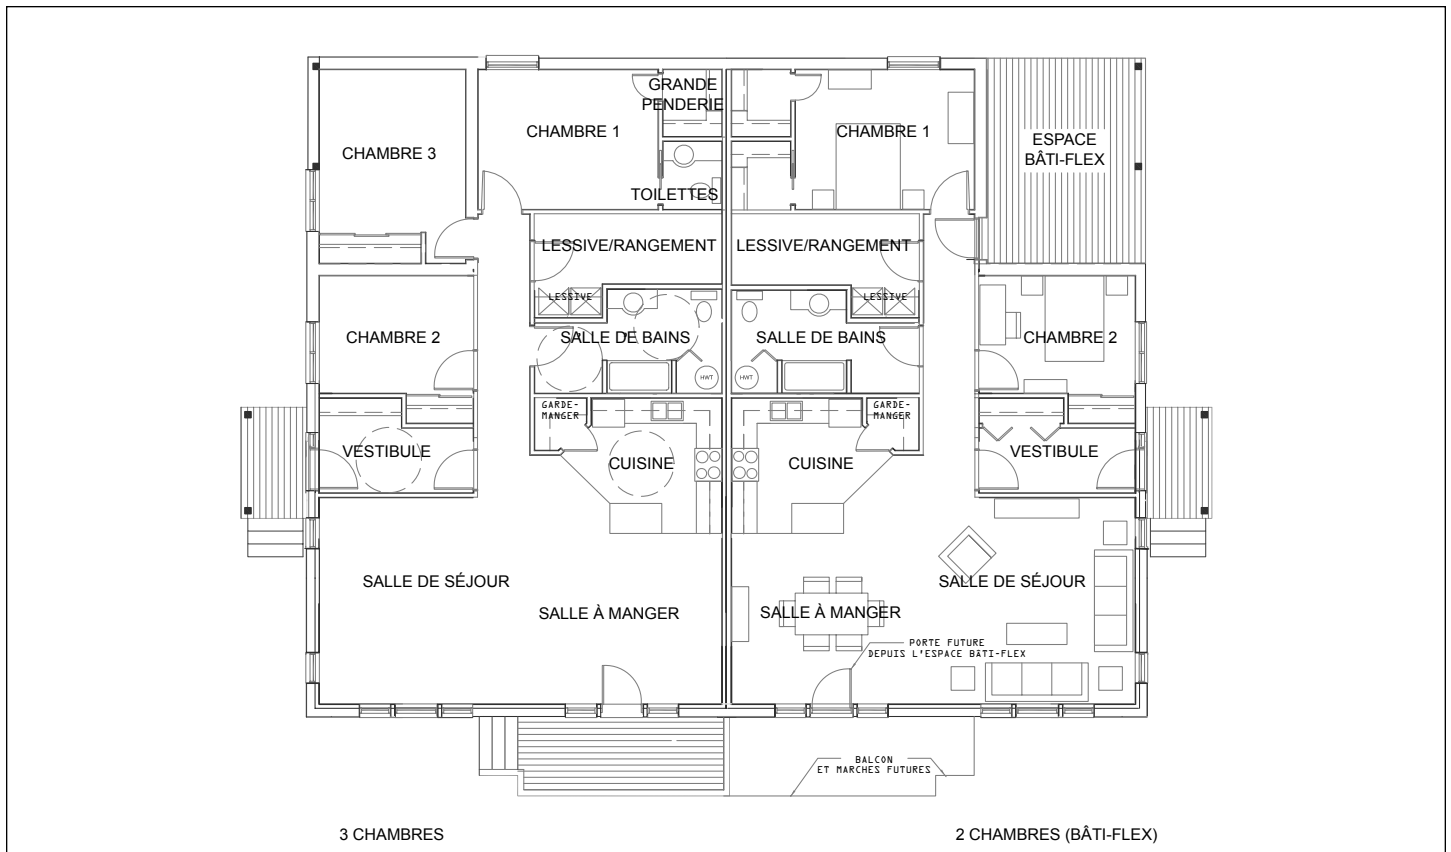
Plan d'étage des logements E/9 (gauche – solaire, droite – Bâti-Flex)
